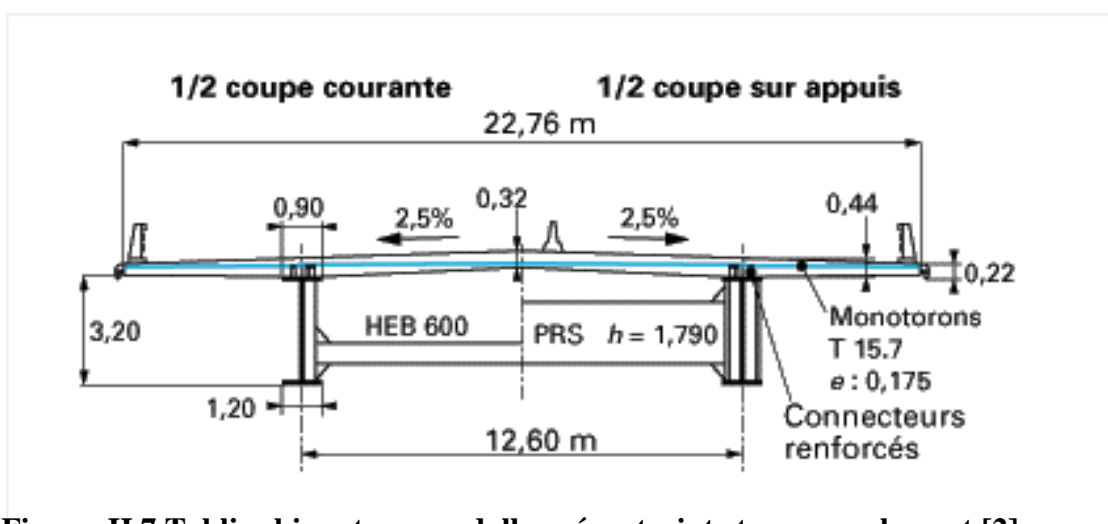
Tablier bipoutre avec dalle précontrainte transversalement [2]
